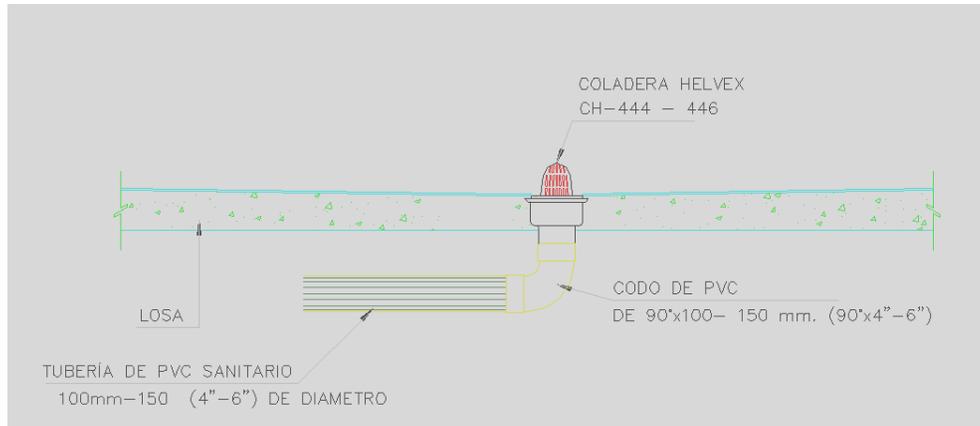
Detalle de colocación de coladeras, con tubería de PVC Sanitario en la azotea del proyecto para colección de agua pluvial.
